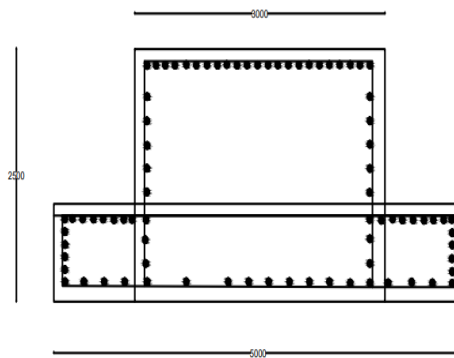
P6 Kolom Tampak Atas dan Bawah
